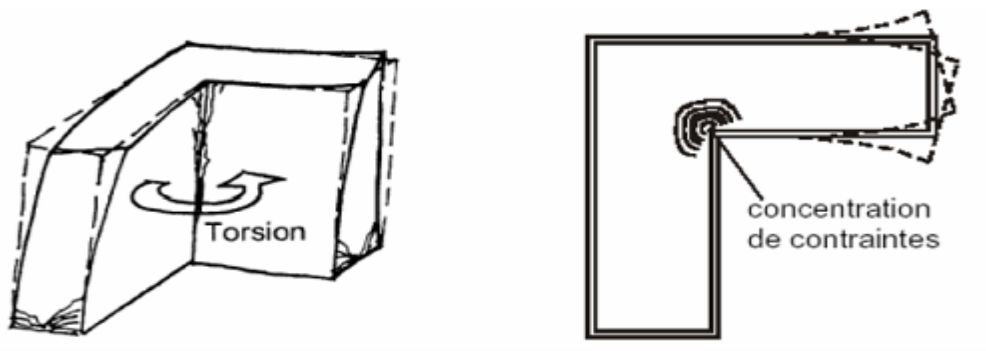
Influence de la géométrie en plan – cas sans joint de dilatation.
